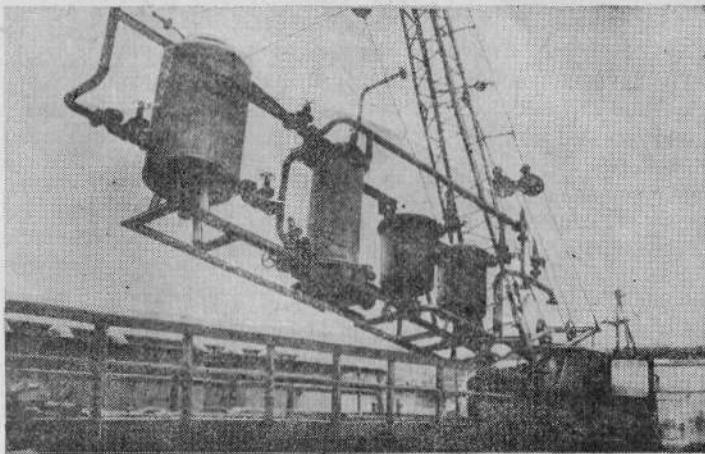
Блок трубопроводов с оборудованием в момент подъема
